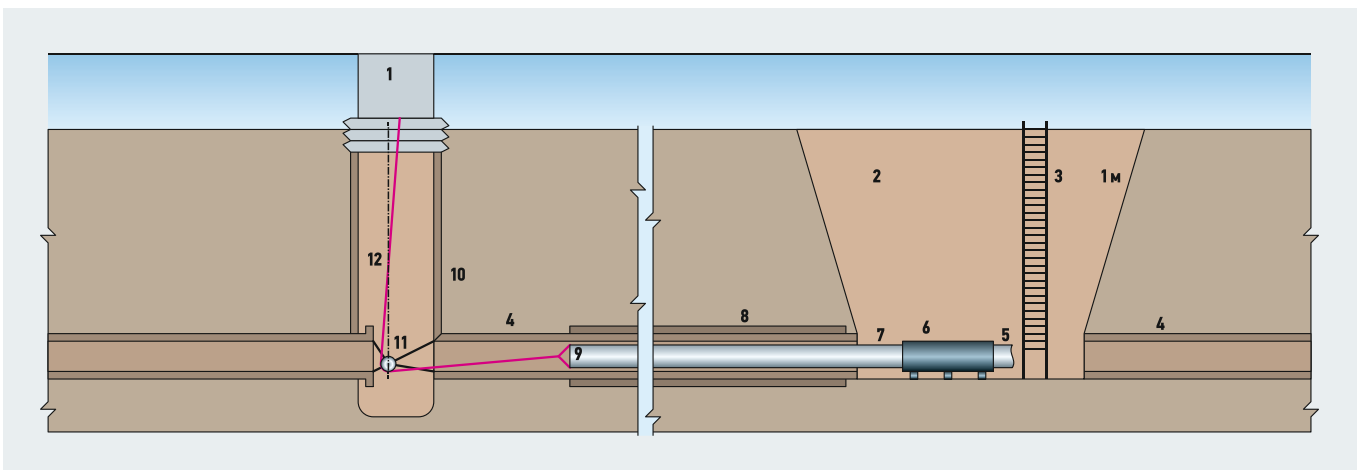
Технологическая схема бестраншейного восстановления трубопровода трубами из ВЧШГ с использованием мощной лебёдки (1 — МЛ; 2 — котлован; 3 — лестница; 4 — восстанавливаемый трубопровод; 5 — присоединяемая труба из ВЧШГ; 6 — узел сборки соединения труб из ВЧШГ; 7 — новый трубопровод из ВЧШГ; 8 — осколки разрушенного трубопровода; 9 — разрушитель-расширитель; 10 — колодец; 11 — опорное устройство для троса; 12 — тяговый трос)
